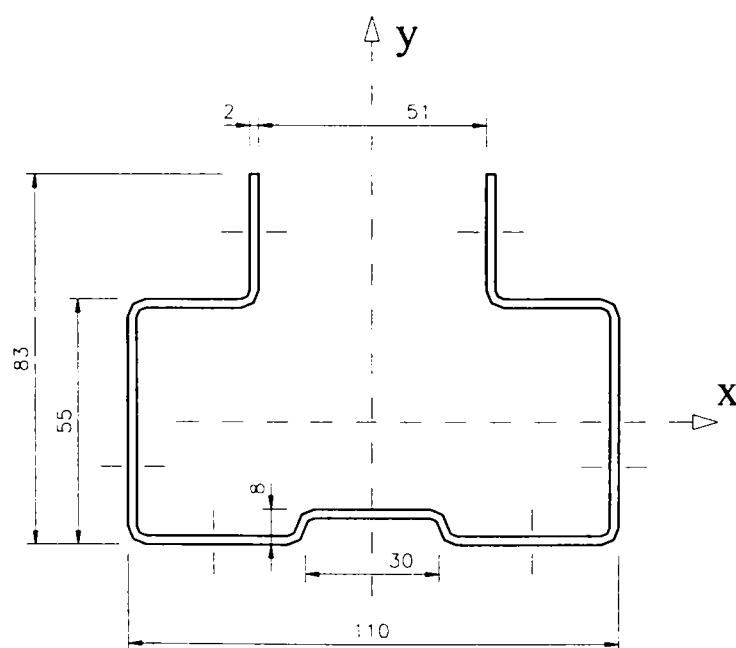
Secțiunea transversală specimenelor Firma C-1 (MSM 1998b)
